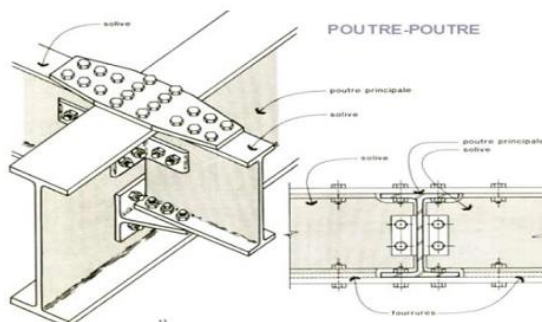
L'assemblage poutre-poutre : L'assemblage de ces deux éléments se fera aussi
